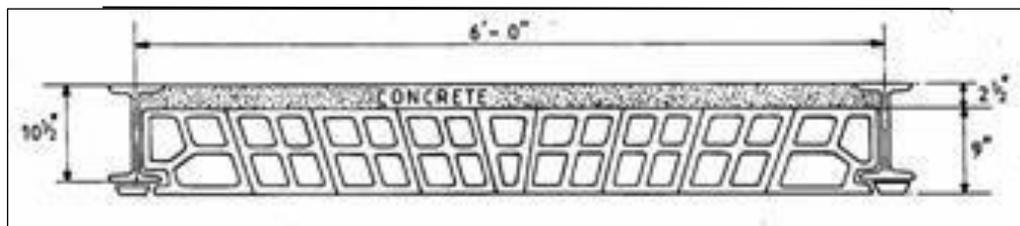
O arco de tijolos como primeira forma de proteção de vigas metálicas
